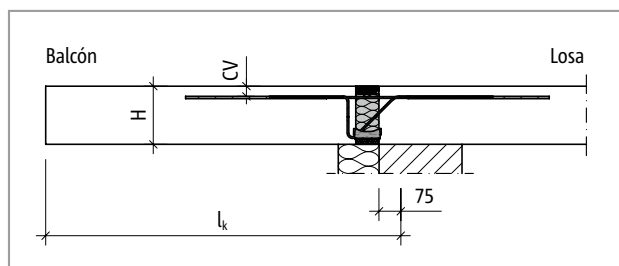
Schöck Isokorb® T tipo K-M1 hasta M11: Sistema estático
